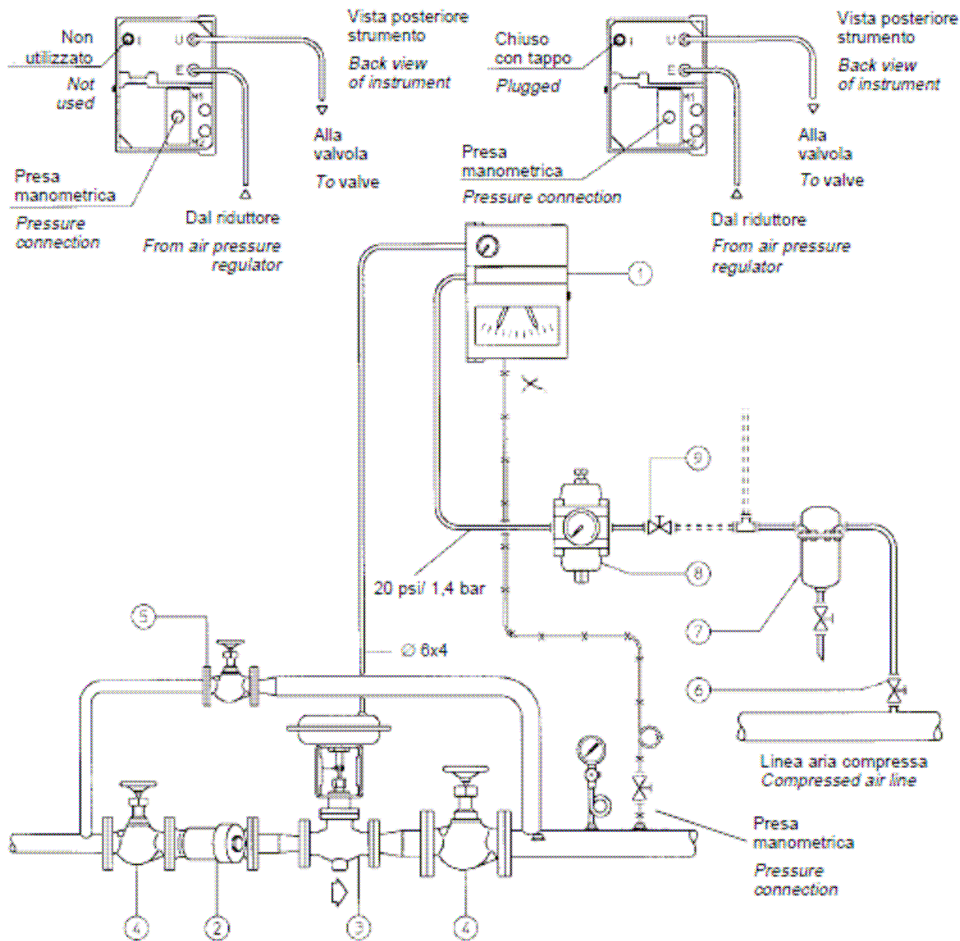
Schema tipico di installazione dei regolatori ad azione P e PI.
